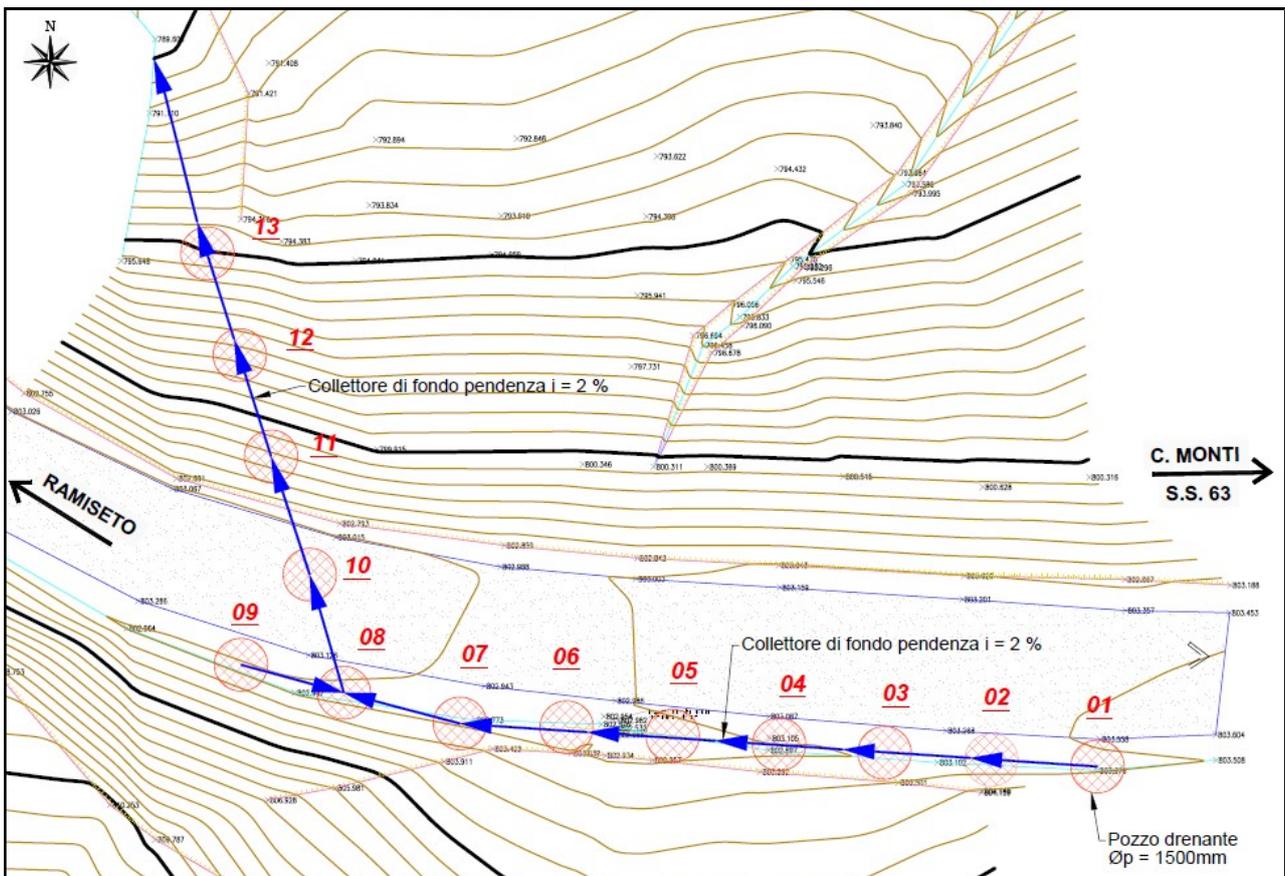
Planimetria di progetto con la disposizione dei pozzi drenanti.
